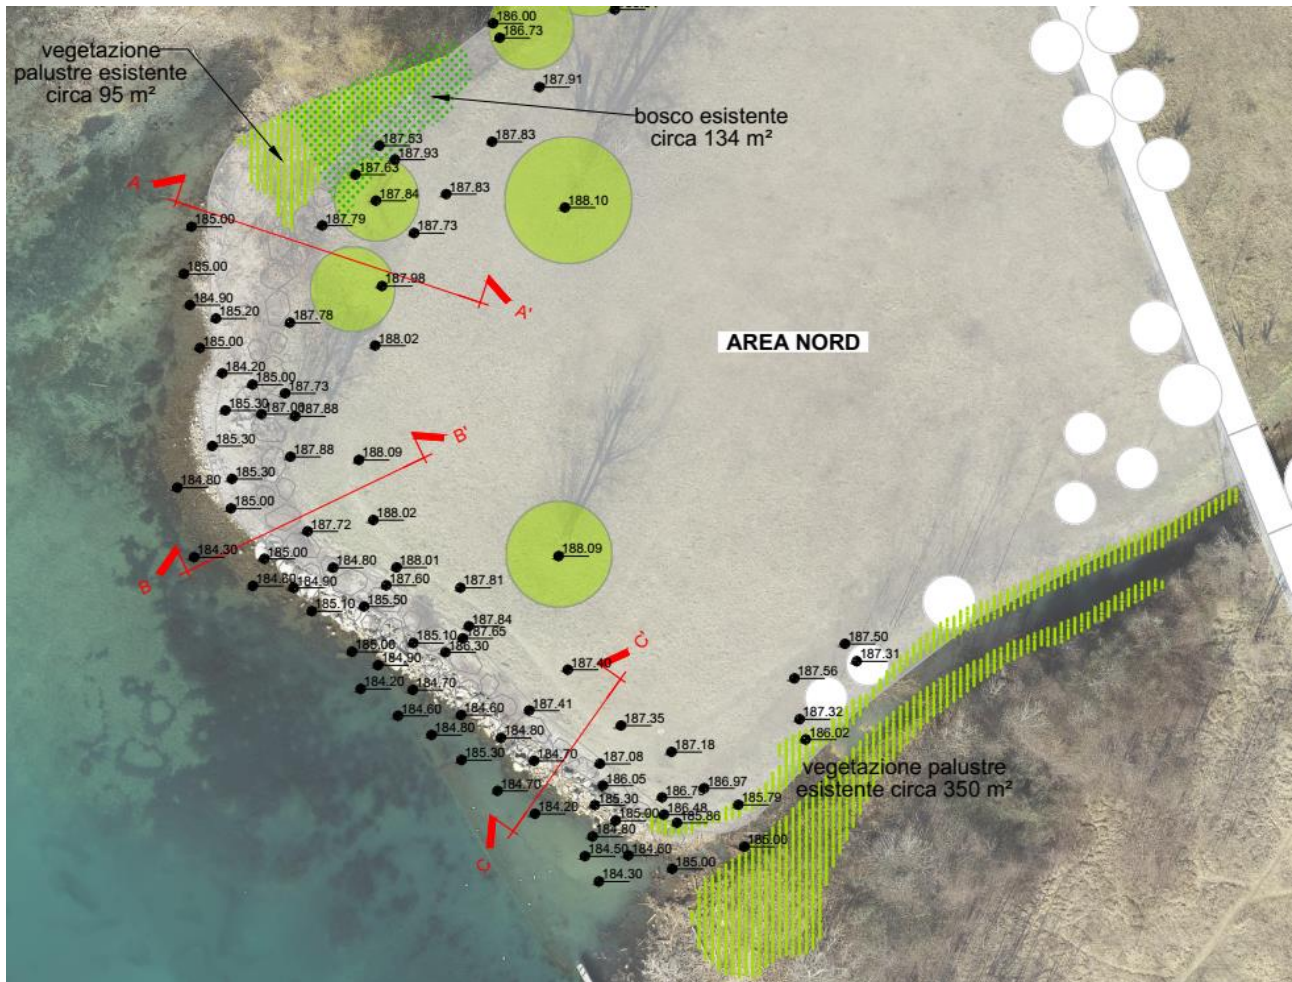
Zoom planimetria stato di fatto area a nord con indicazione sezioni
